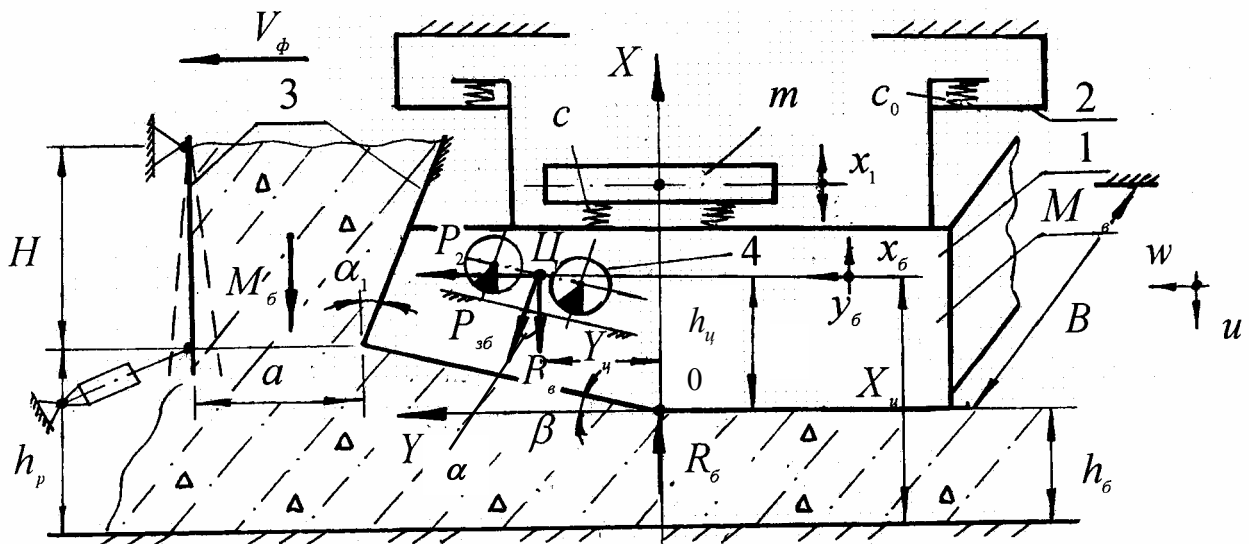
Розрахункова схема поверхневого віброущільнювача.
